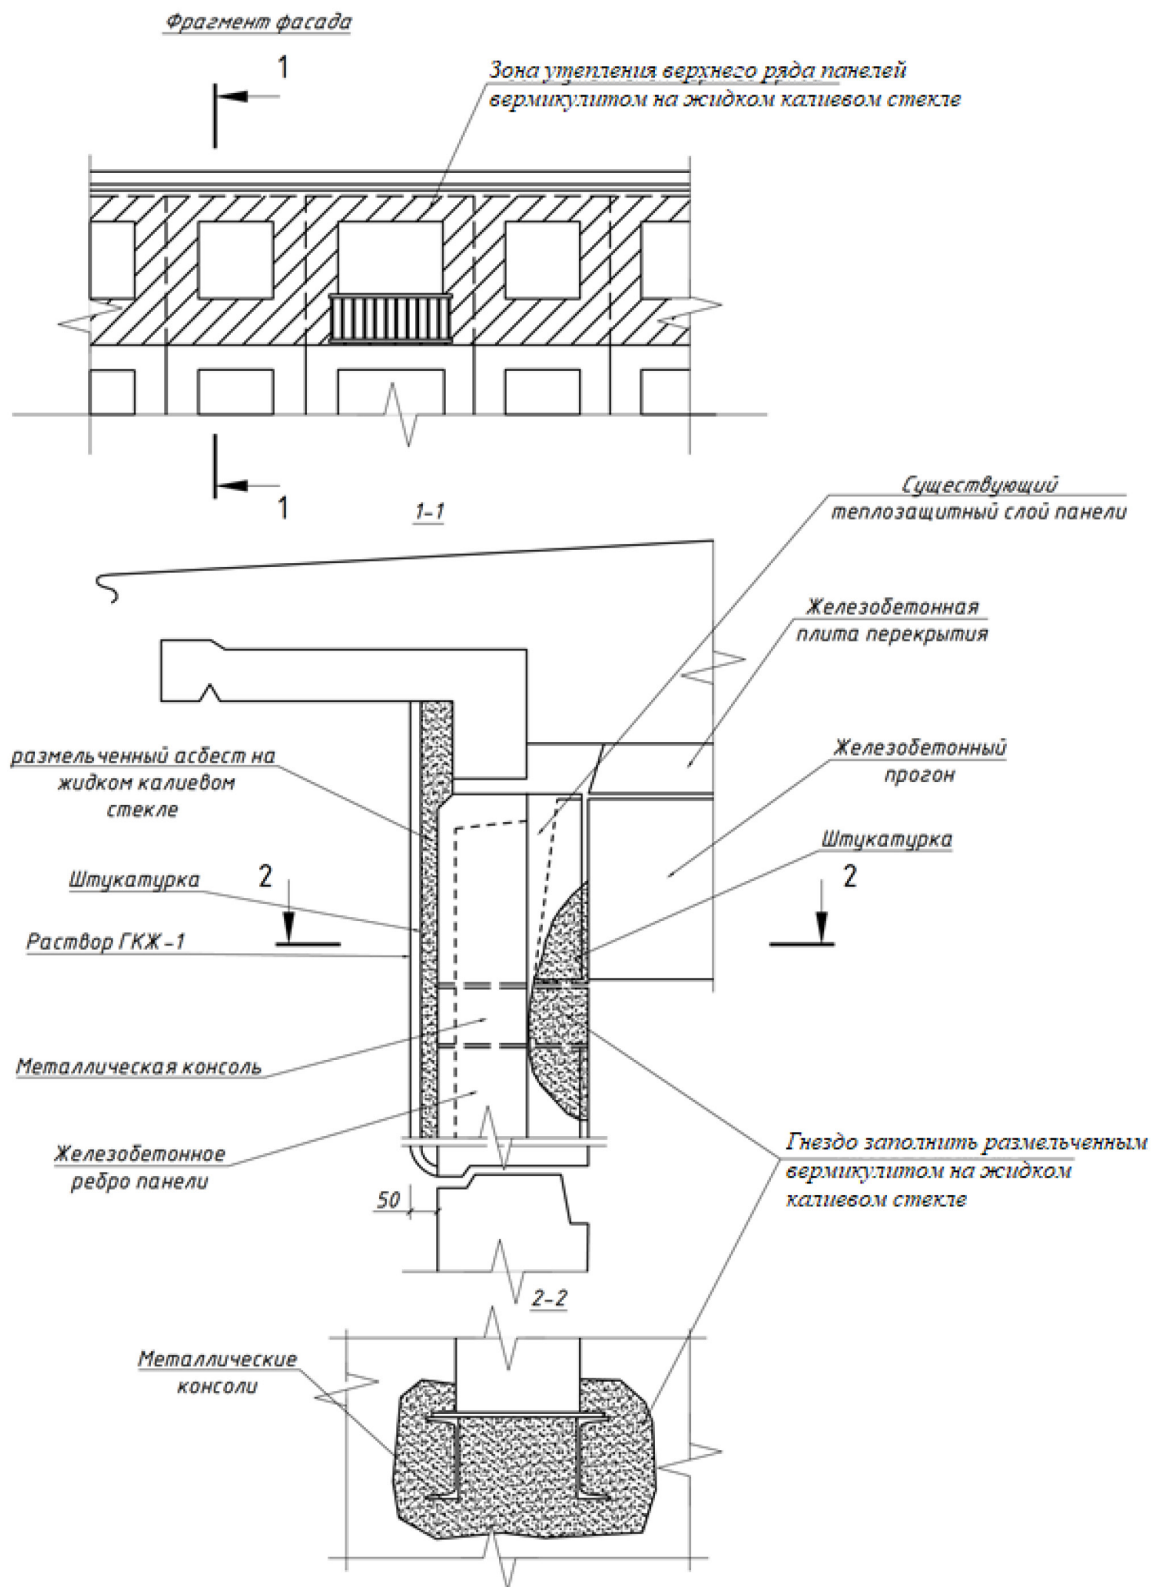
Утепление переохлажденных зон со стороны помещения
